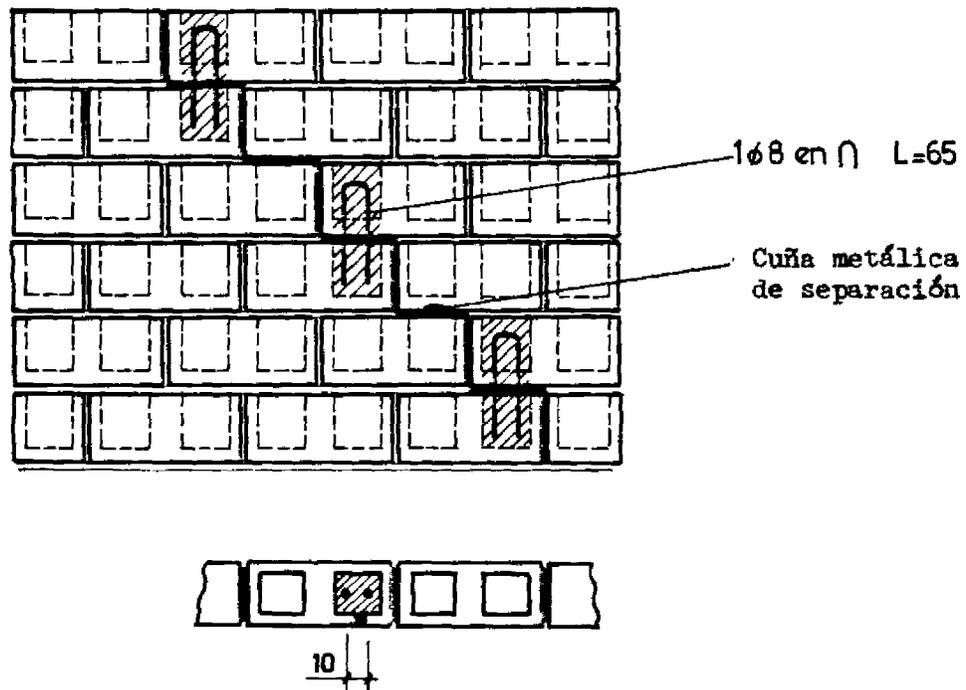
Caso A-4. REPARACION DE MURO DE ALBAÑILERIA DE BLOQUES DE MORTERO, CON MORTERO PROYECTADO
